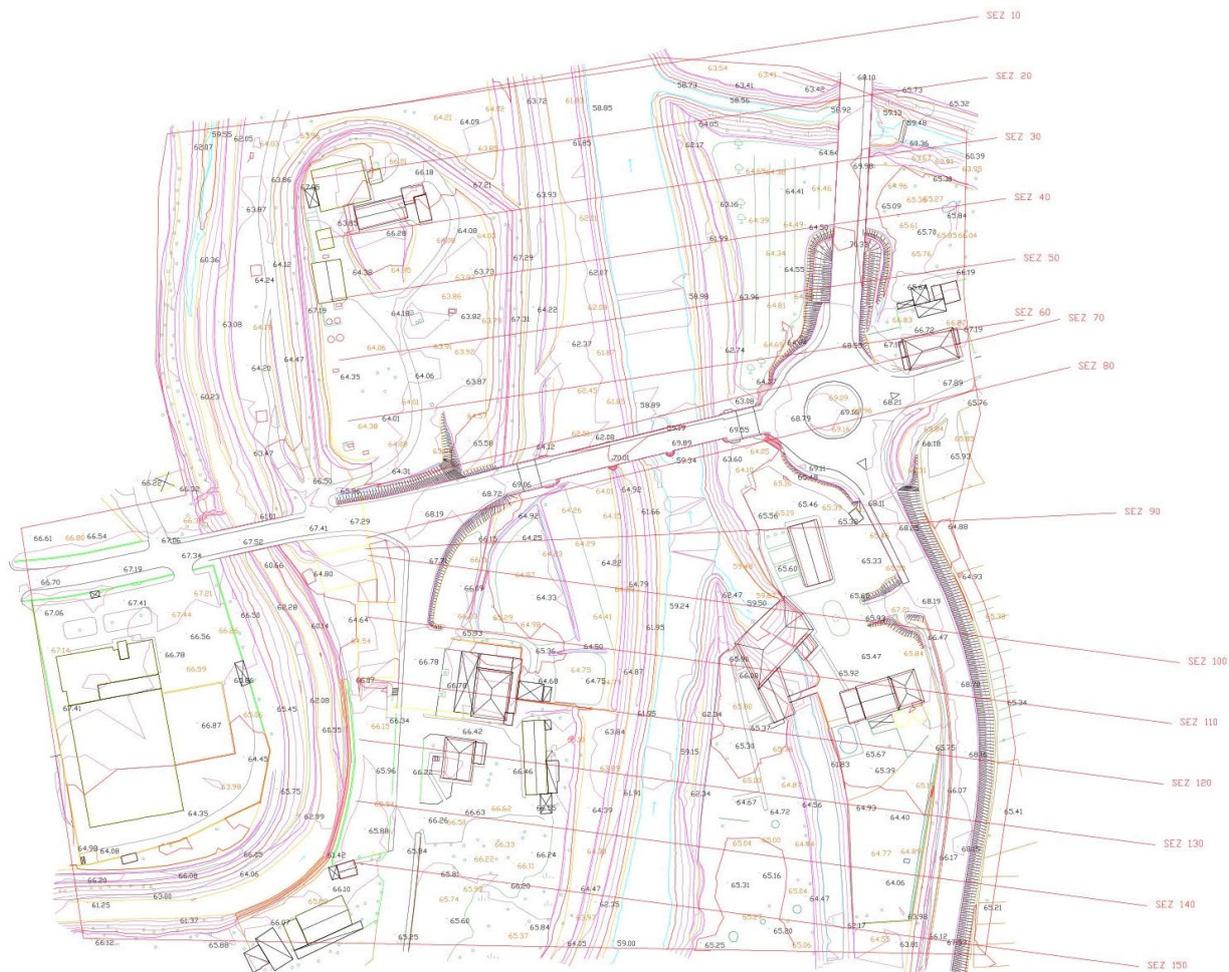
Rilievo di dettaglio dell'area e traccia delle sezioni estratte
